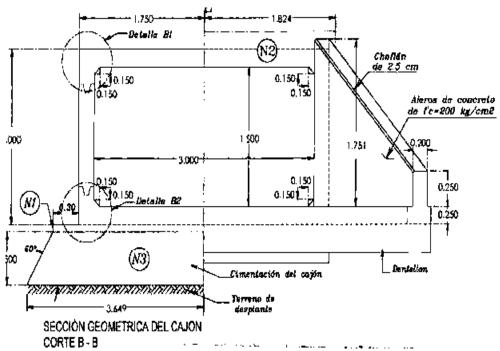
Plano para la colocación del concreto, elaborado por la constructora de autopistas de Michoacán.
